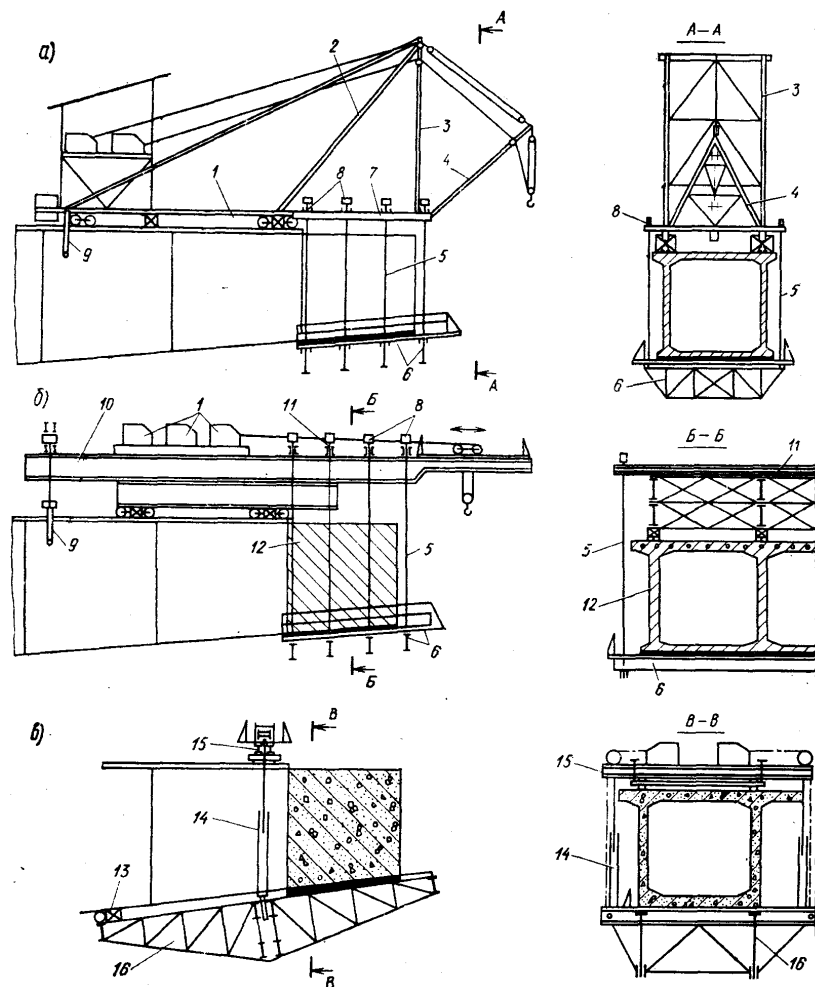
Агрегати для навісного бетонування балкової прогонової будови:
